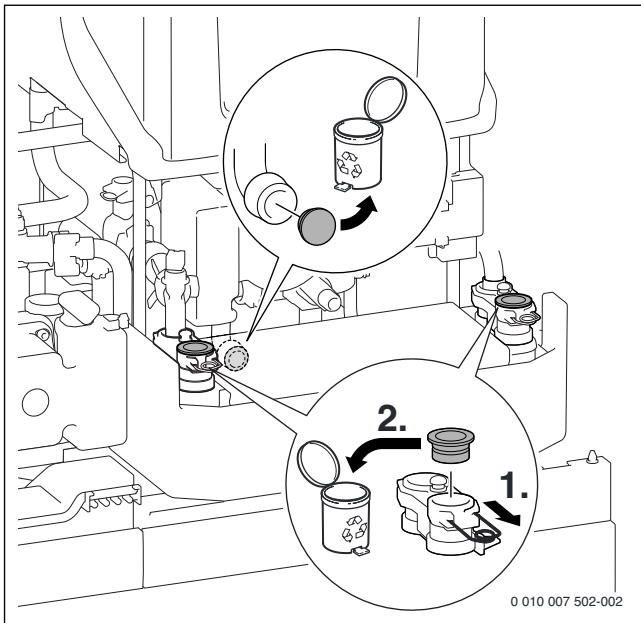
Retirer le bouchon sur le corps de chauffe et l'échangeur à plaques
